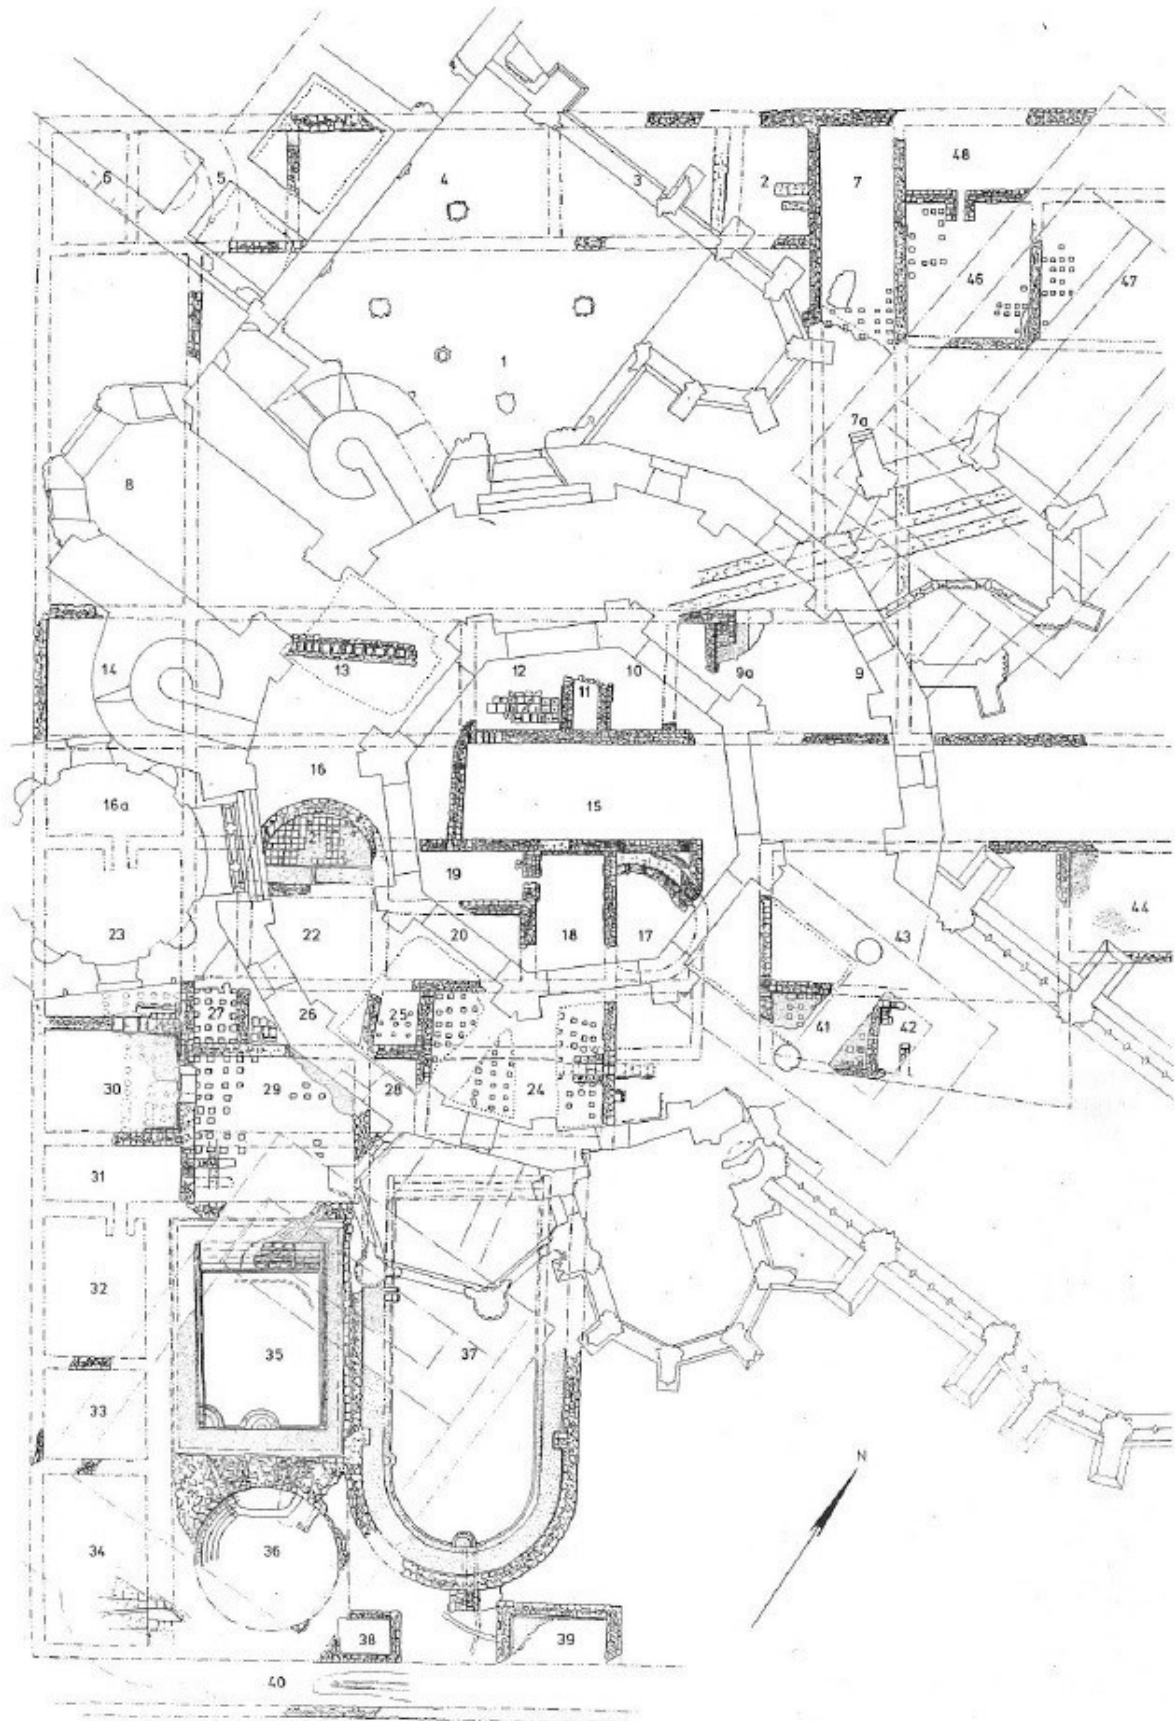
Planimetria dell'impianto detto Münsterthermen. Fonte: Baur *et al.* 2012, p. 99 fig. 2.
